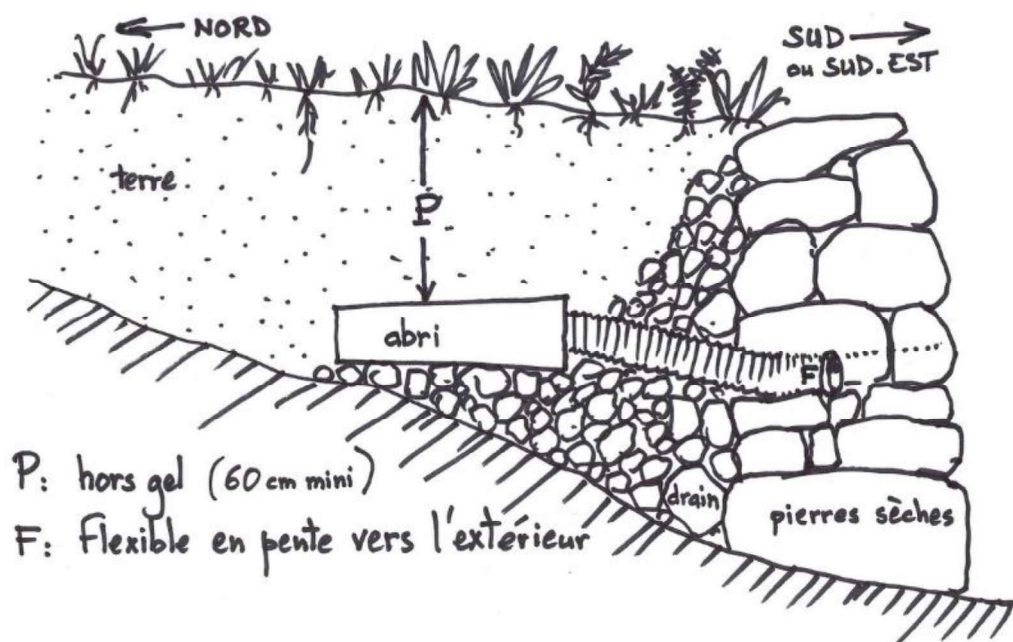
Exemple de construction de muret (Source : association BEED Bassin de l'Eyrieux Environnement Développement)
